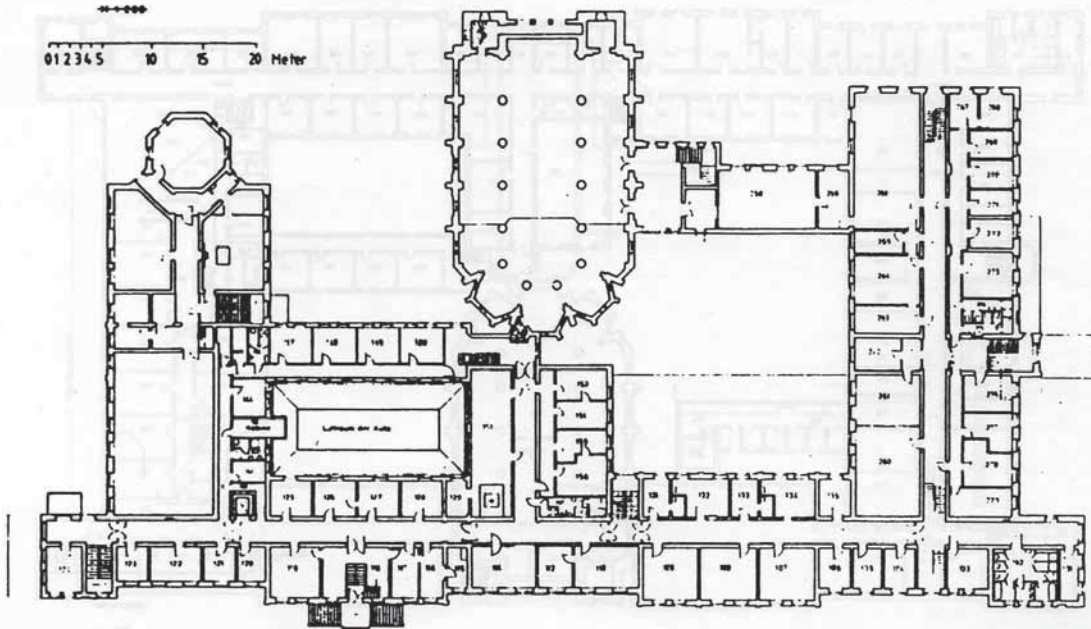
Grundriss des Missionshauses (Erdgeschoss und 1. Obergeschoss), aufgenommen 1978
